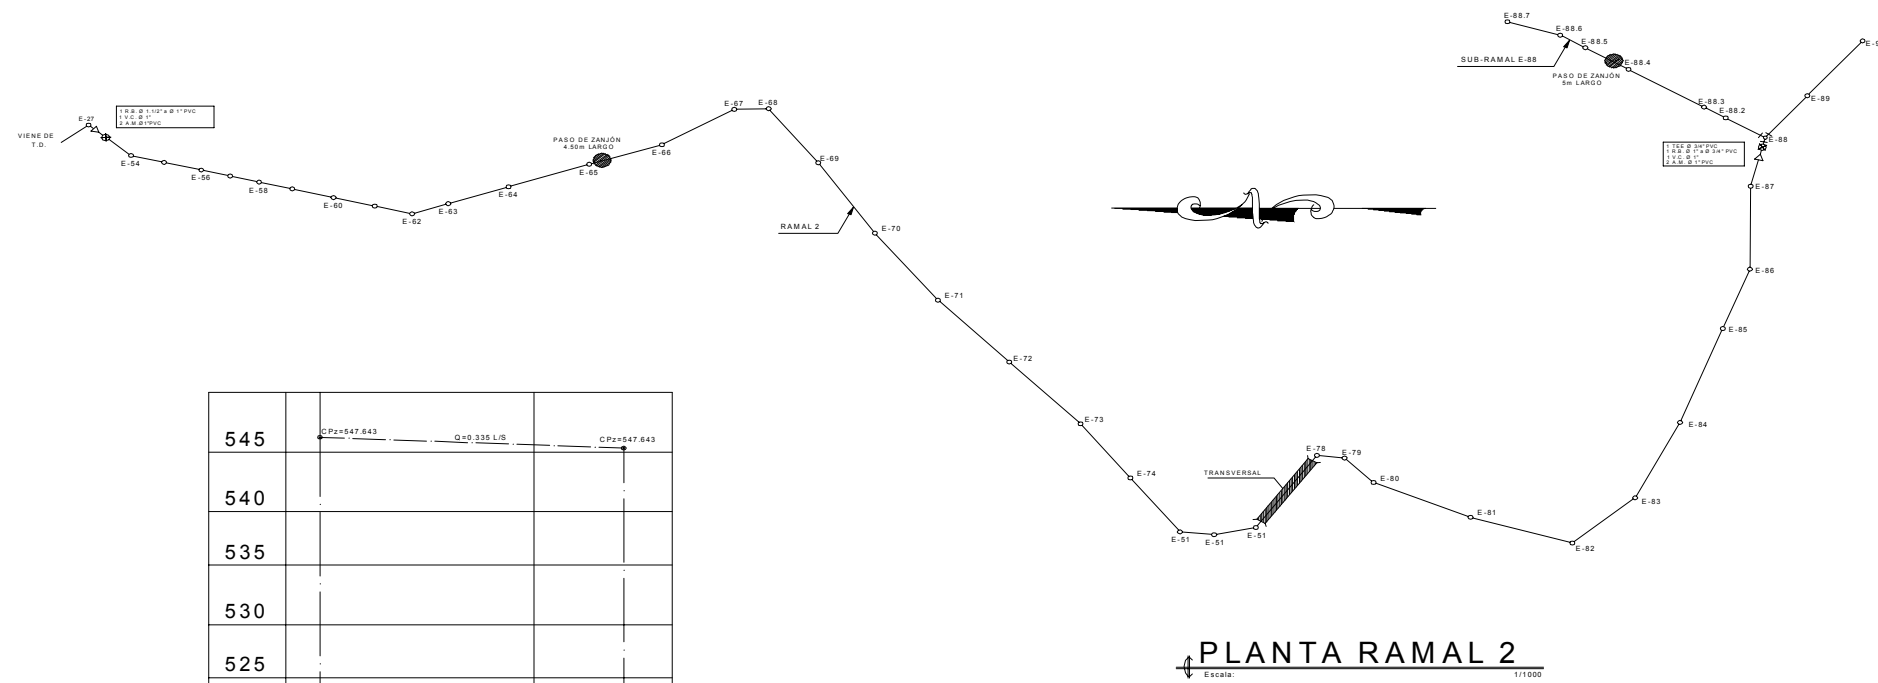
Plano de planta ramal 2 y perfil sub-ramal E-88
